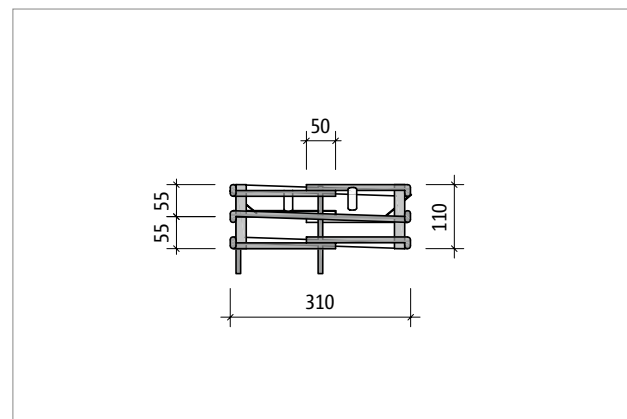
Schöck Sconnex® Typ P-B350: Seitenansicht Part T; geschweisste Bügel und Biegeformsegmente aus Edelstahl
